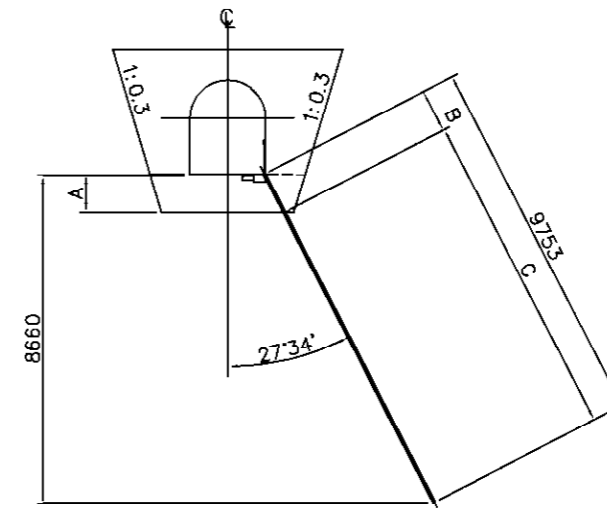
(11) 浸透流観測孔配置図 (1)
